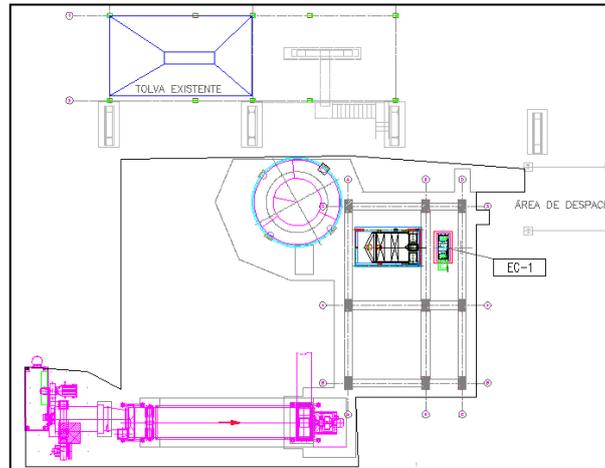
ÁREA DEL ELEVADOR DE CANGILONES¹
